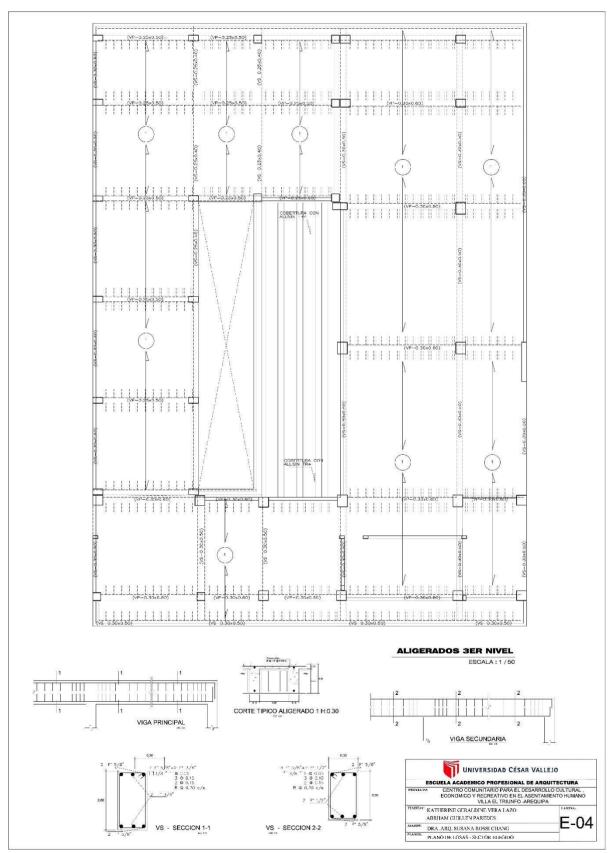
Plano de Aligerados Tercer nivel - Elaboración propia
